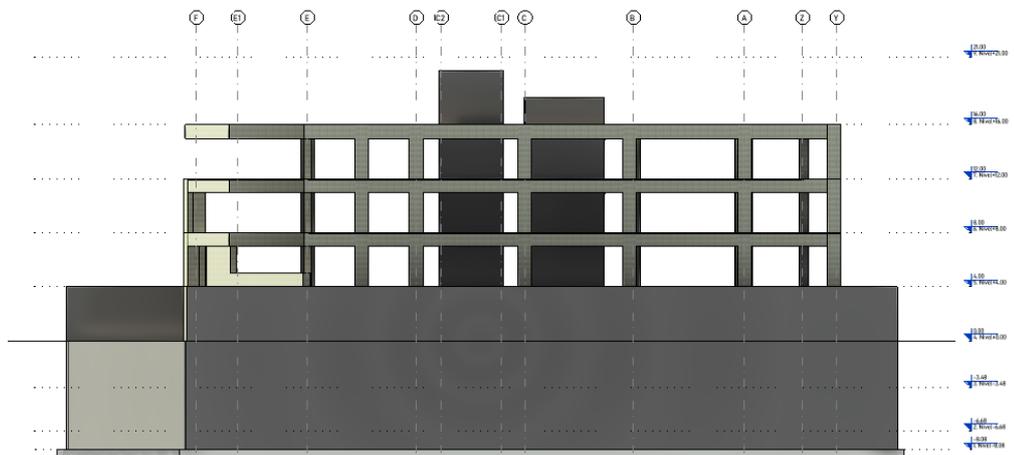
Fachada Norte Modelo Estructural 3D. (Elaboración Propia)
